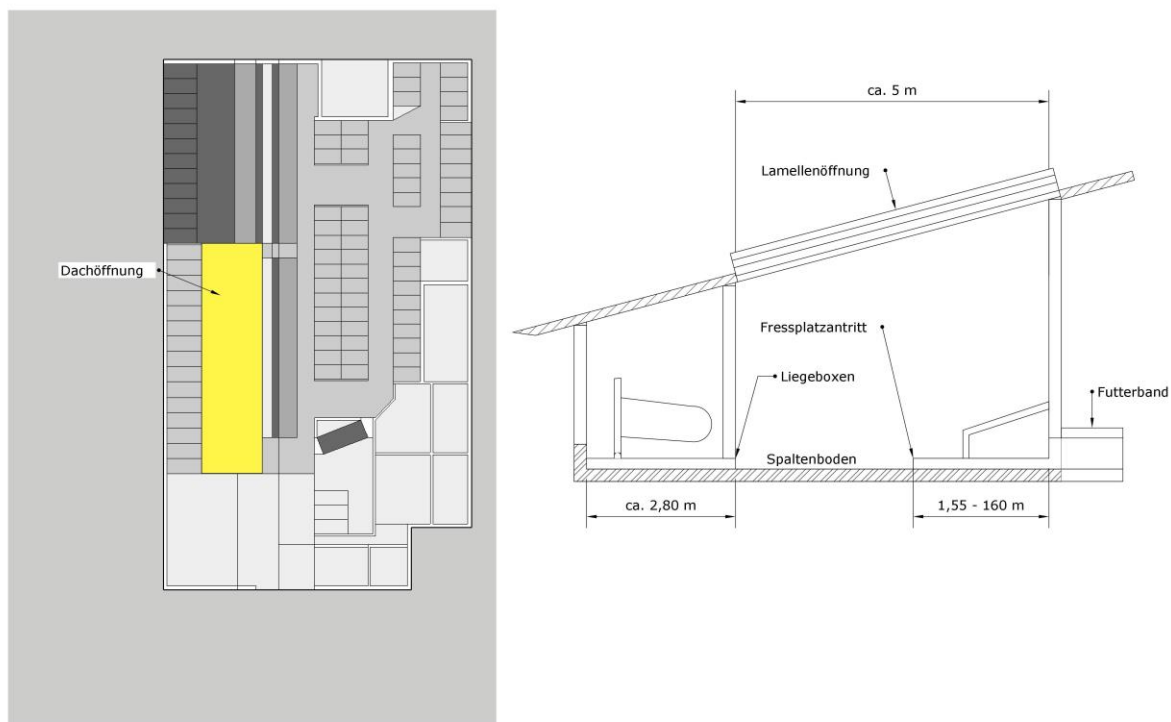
Geplante Öffnung des Daches zur Optimierung des Stallklimas
